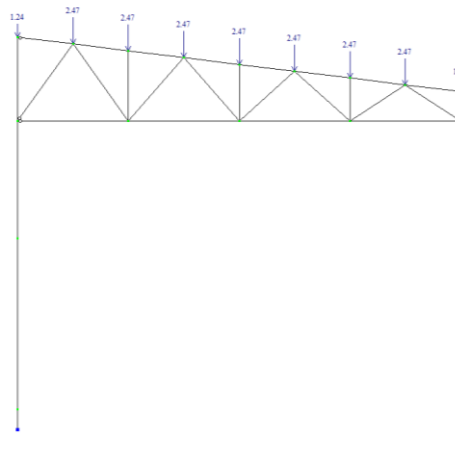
Загружение 2. Нагрузка от веса покрытия
